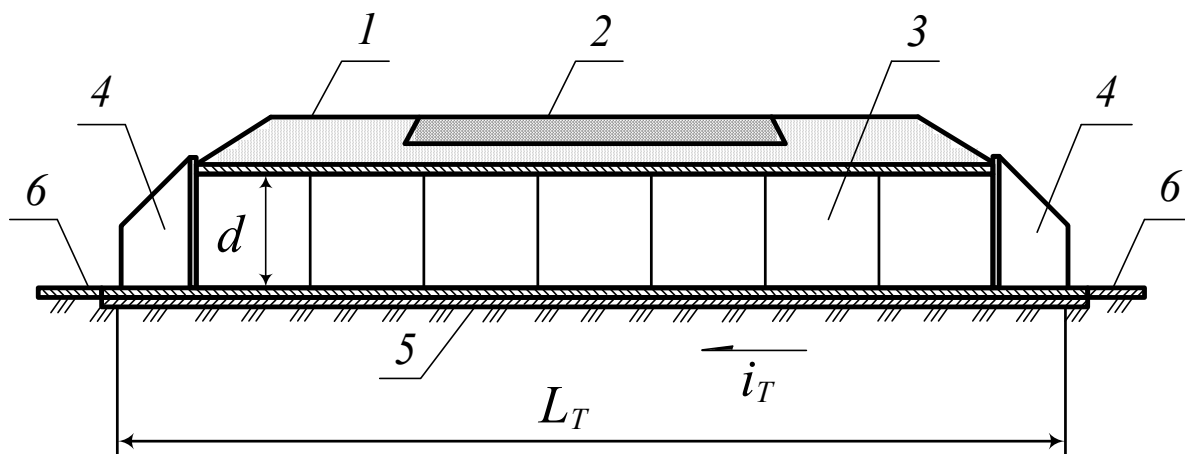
Круглая железобетонная труба (разрез по продольной оси):
